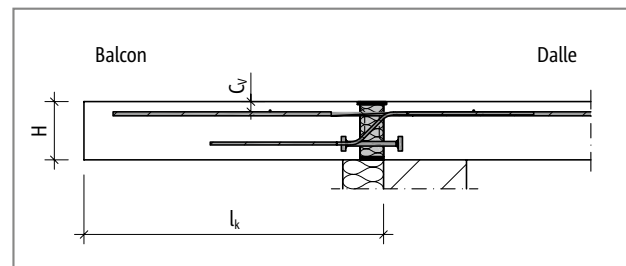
Schöck Isokorb® T Type K-M12 : Système statique
